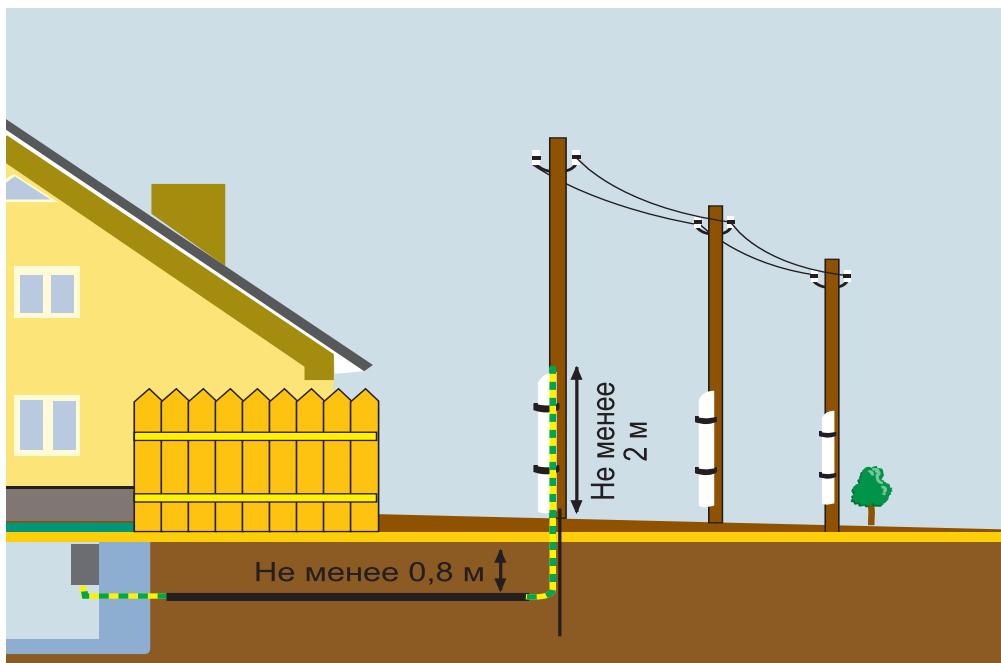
Глубина траншеи должна быть не меньше 0,7–0,8 м; труба, защищающая кабель, поднимается на столб на высоту 1,8–2 м. Монтаж подземного подвода начинается с крепления трубы на опору и на стену дома. Г-образно изогнутые трубы поднимаются на опору и стену дома на высоту не менее 1,8 м и уходят в землю на глубину пролегания кабеля, где изгибаются и идут под землей (обычно это расстояние не превышает 50 см). В идеале лучше всего, когда труба защищает кабель на всем пути его прокладки, но это не обязательно. Если нет трубы достаточного размера, то можно ограничиться защитой входа кабеля в землю и на открытом воздухе. Это самый простой и дешевый способ проводки под землей. Надо сразу сказать, что не всякий кабель годится для прокладки в грунте без защиты. На эту роль лучше всего подойдет бронированный ВББШв
